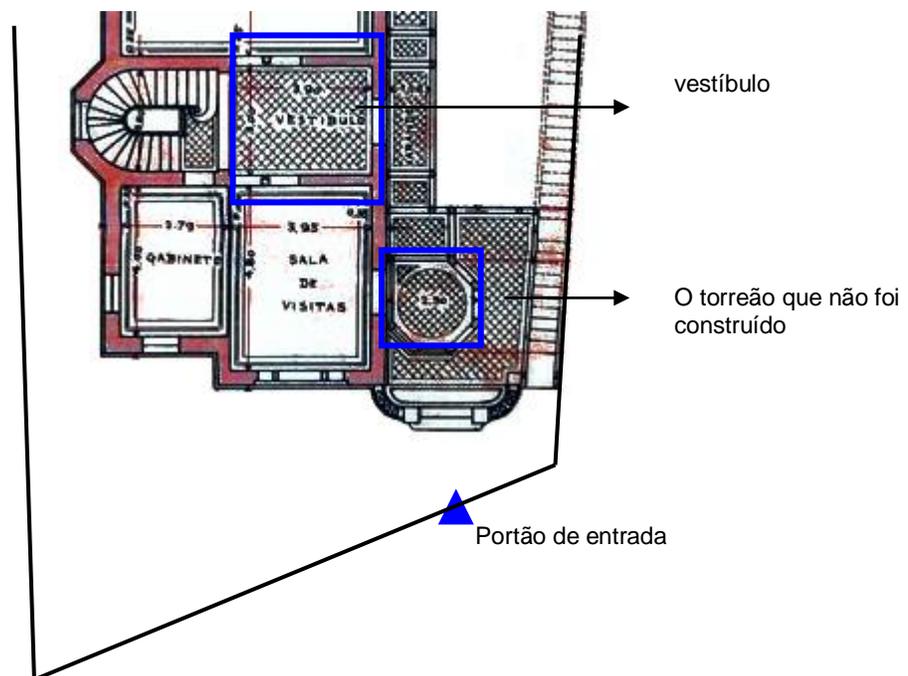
Detalhe da planta baixa do pavimento de acesso
